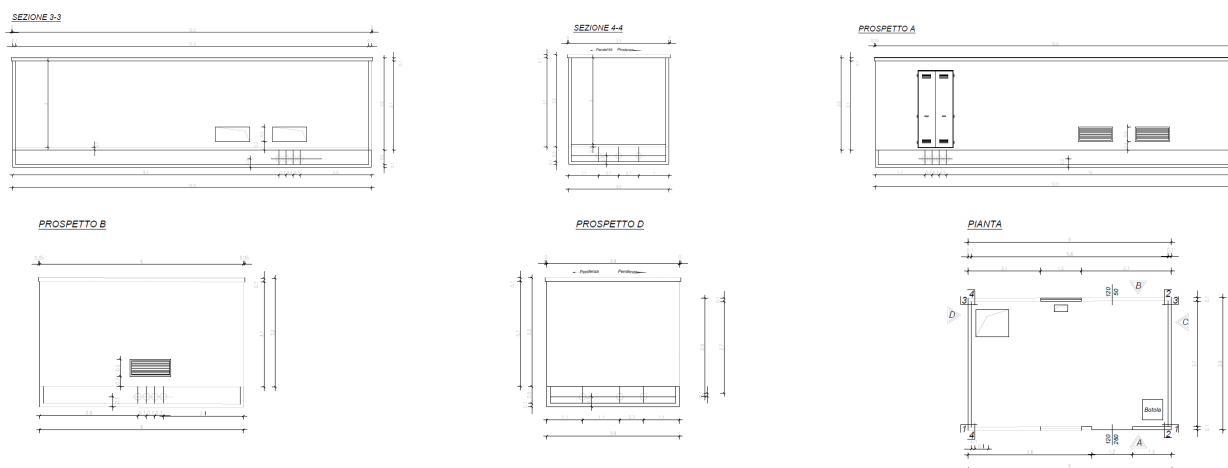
sezione e prospetto delle cabine di campo; prospetto e pianta delle cabine di sottocampo.
